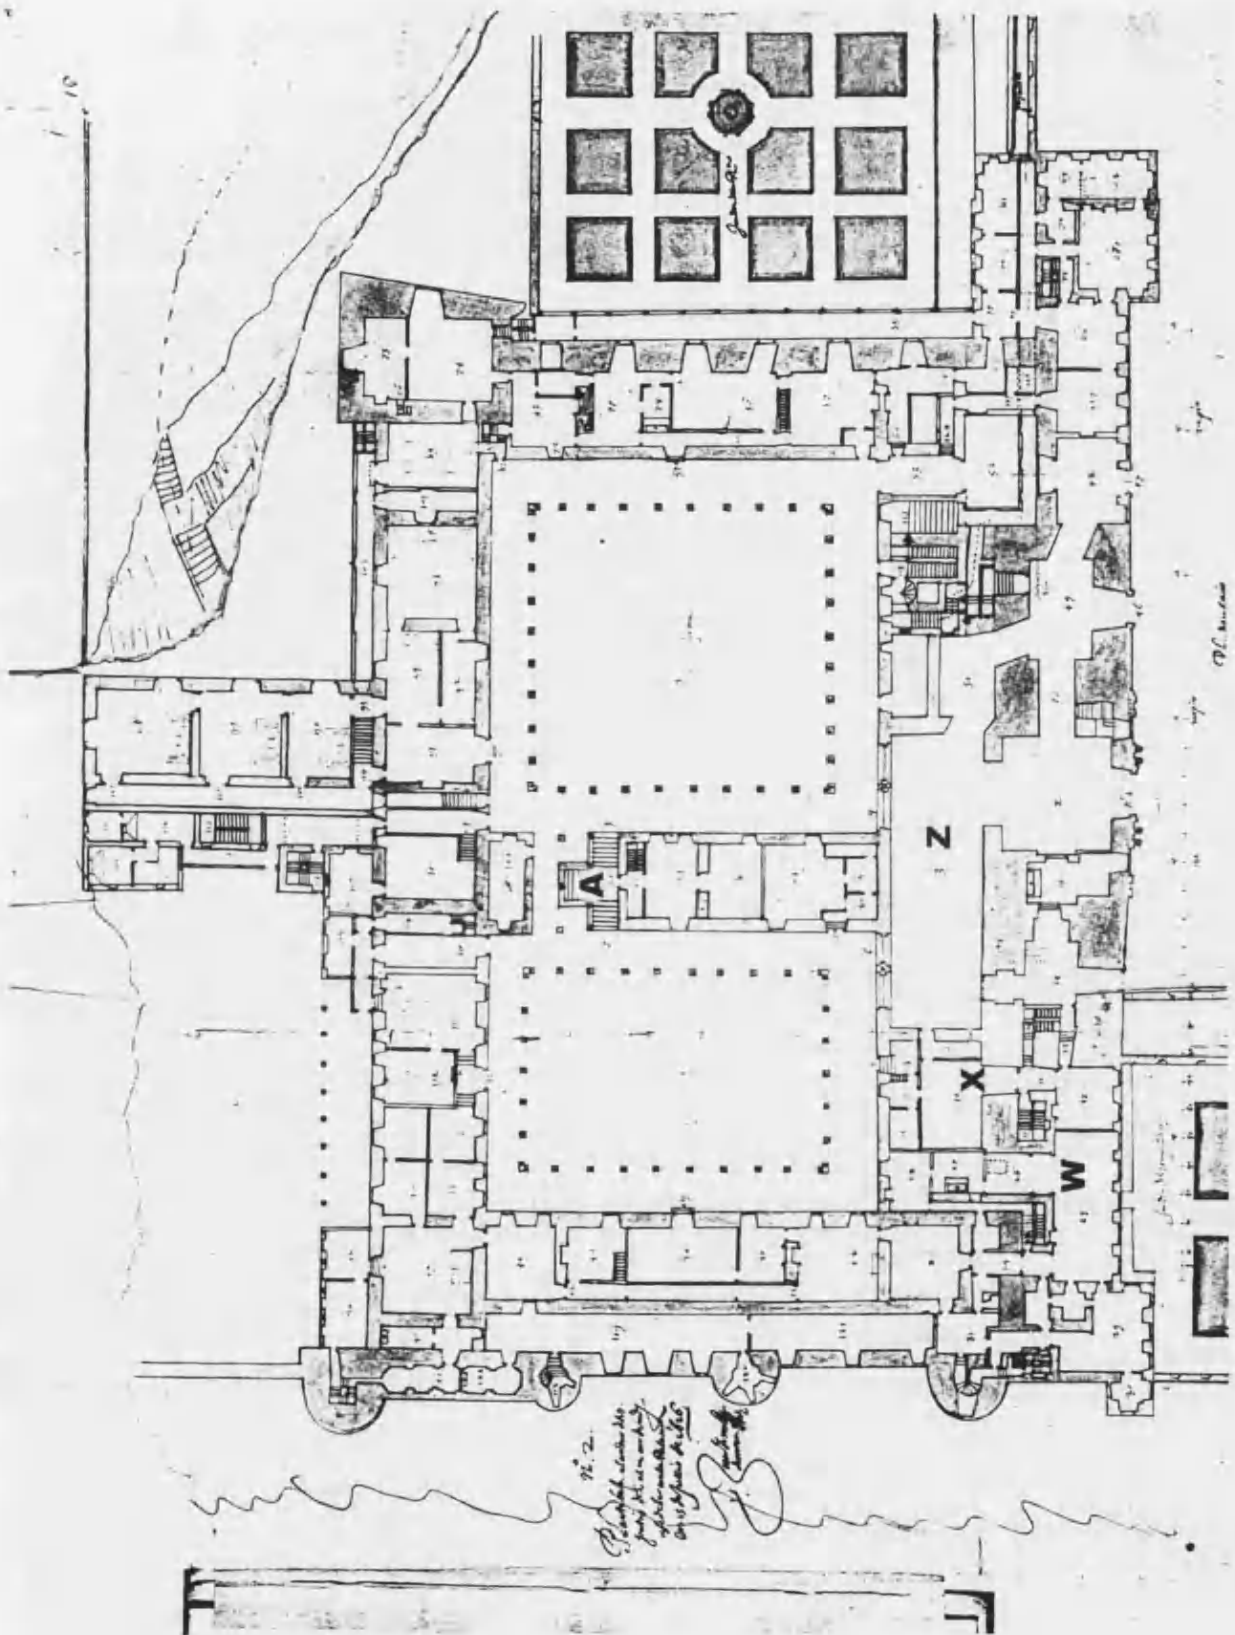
Juan Gómez de Mora. *Planta baja del Alcázar de Madrid*. 1626. Biblioteca Vaticana.
